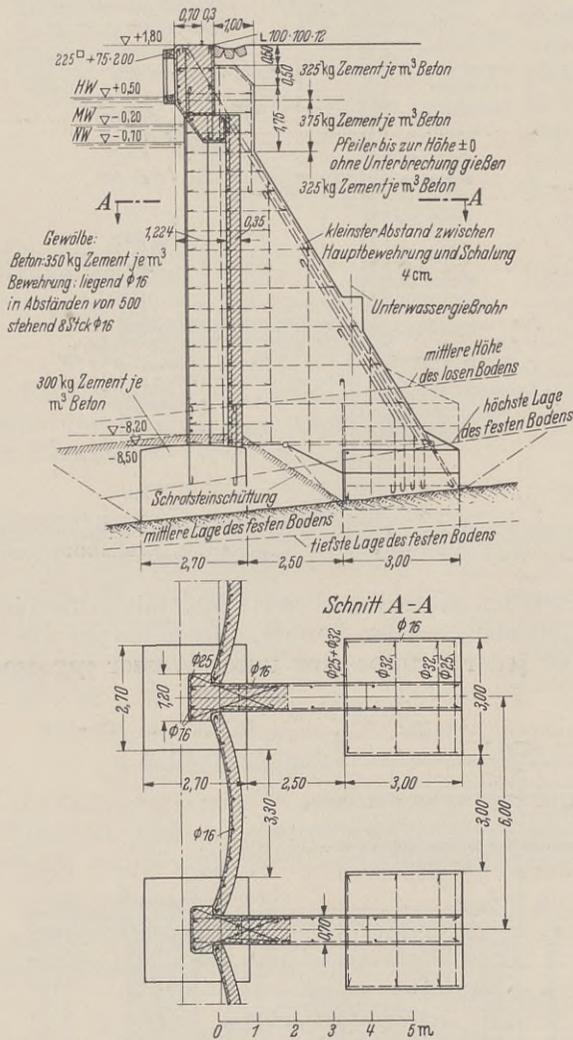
Leichte Eisenbetonkonstruktion auf festem Boden, Ausführung unter Wasser, Härnösand, 1935.
